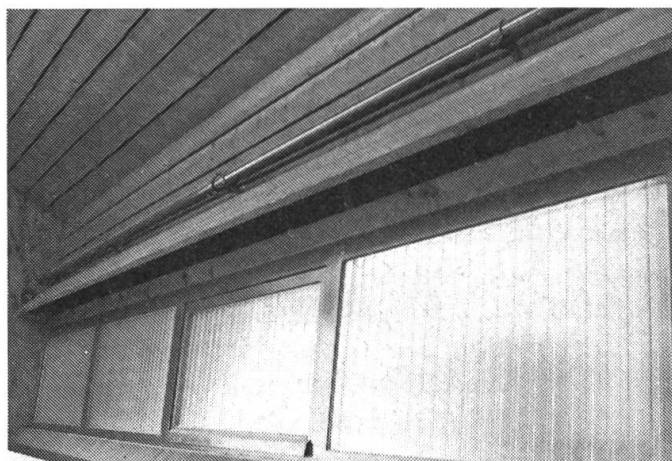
Les bouches admettant l'air entrant disposées le long des murs peuvent être ouvertes et fermées manuellement.
